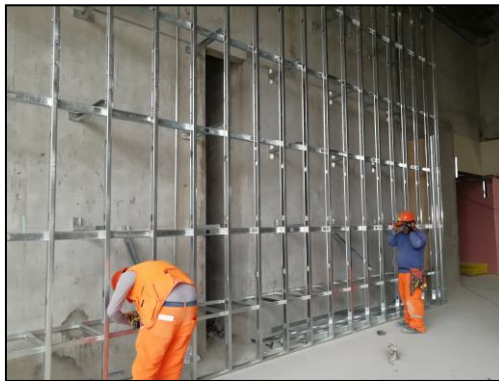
Instalación de perfilera y planchas de drywall en altura, sótano 1.
